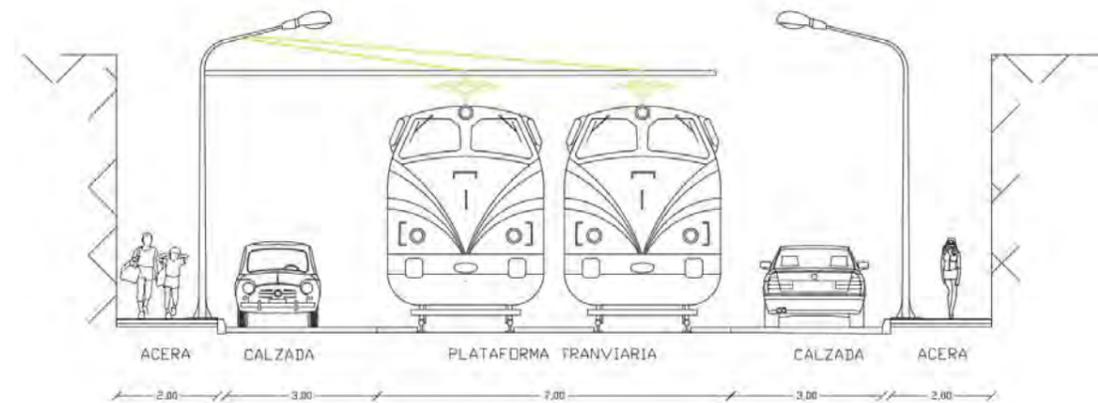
Sección tipo D (cotas en m). Fuente: Elaboración propia
